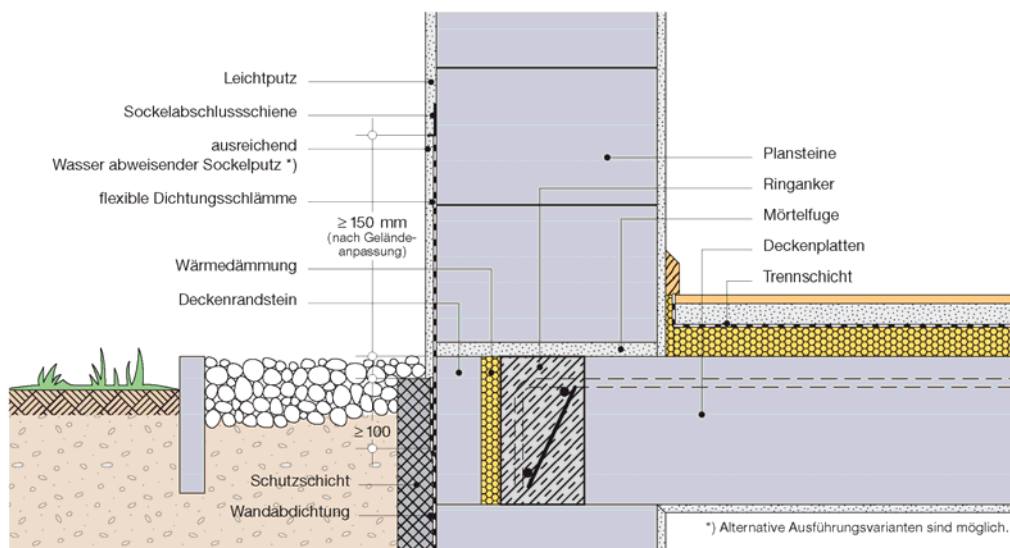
Sockelausbildung bei einschaligem Mauerwerk aus Porenbeton
